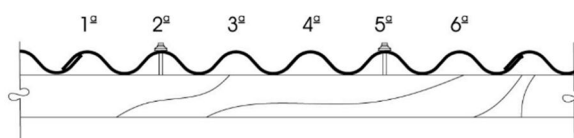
Detalhamento de montagem, posição de fixação, segundo o fabricante
